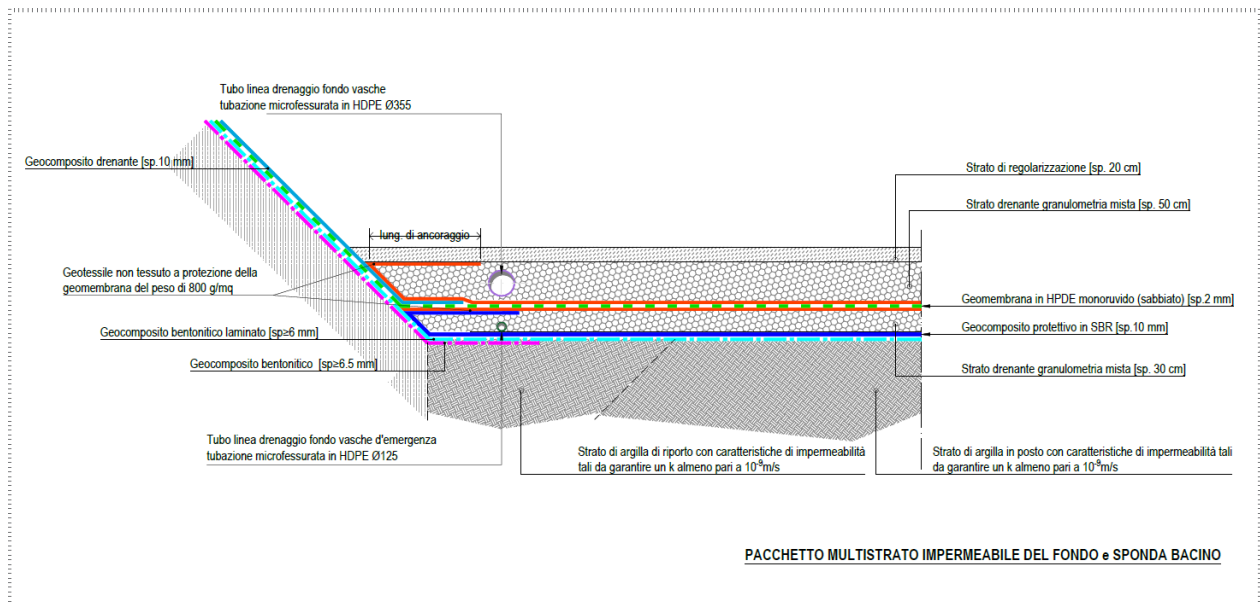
SEZIONE TRASVERSALE DETTAGLIO SEZIONE DI POSA RETI DI DRENAGGIO
